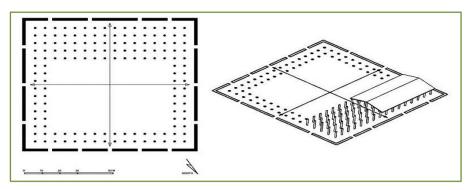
Plan et vue générale de Koufa mosquée, montrant le plan carré avec cinq nefs sur le côté de la qibla. (Source : Archnet.org)
